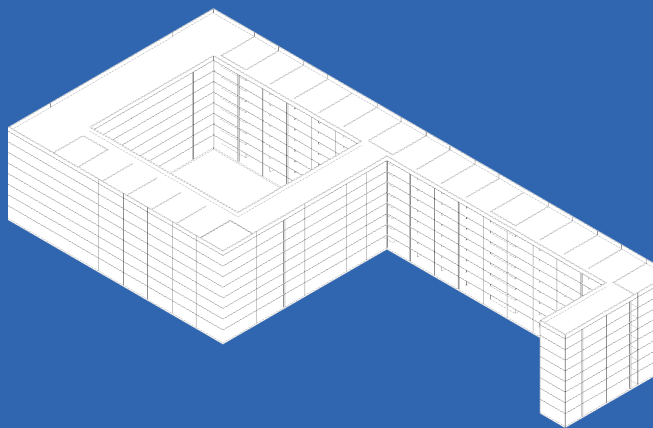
Axonométrica esquemática de la estructura del proyecto utilizando hormigón armado.
